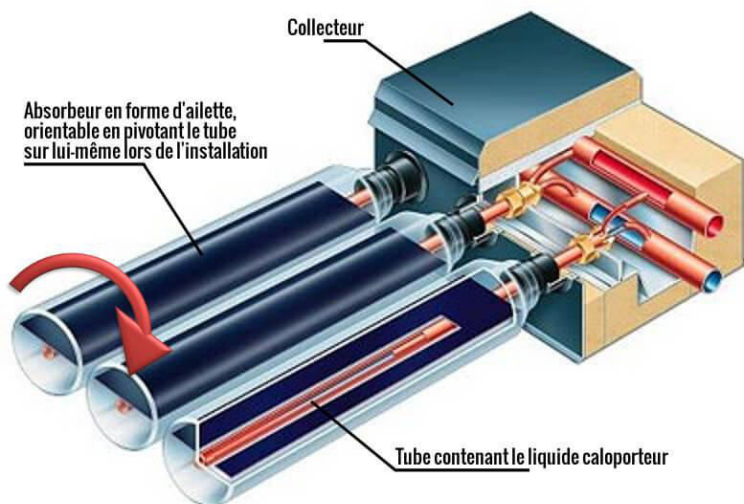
La construction de panneaux solaires avec tubes sous vide
